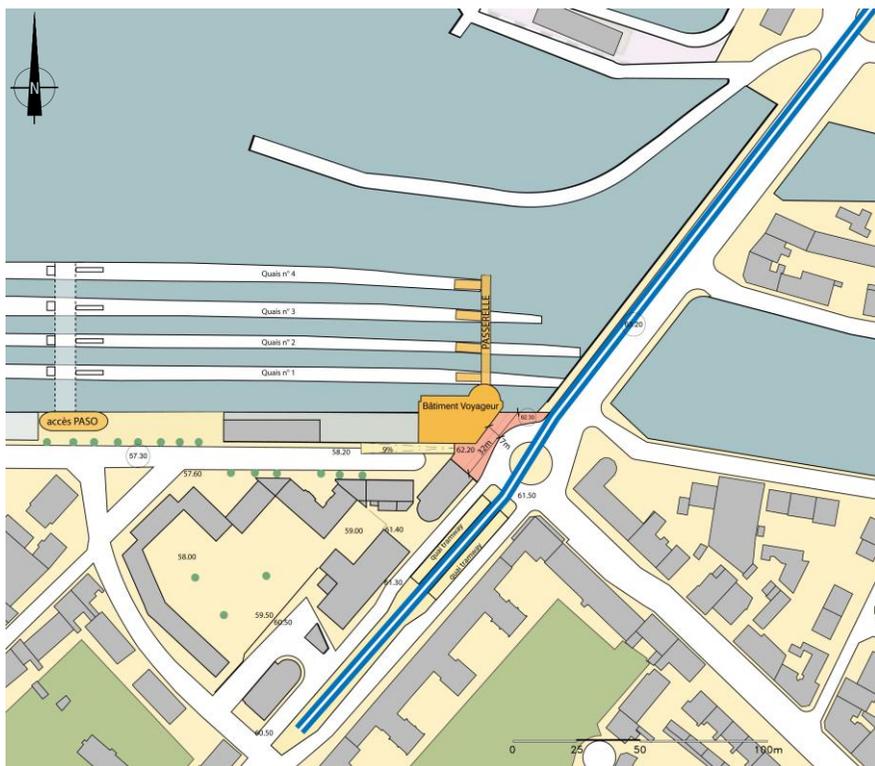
plan de la situation existante du pôle de Noisy-le-Sec - source : Egis
